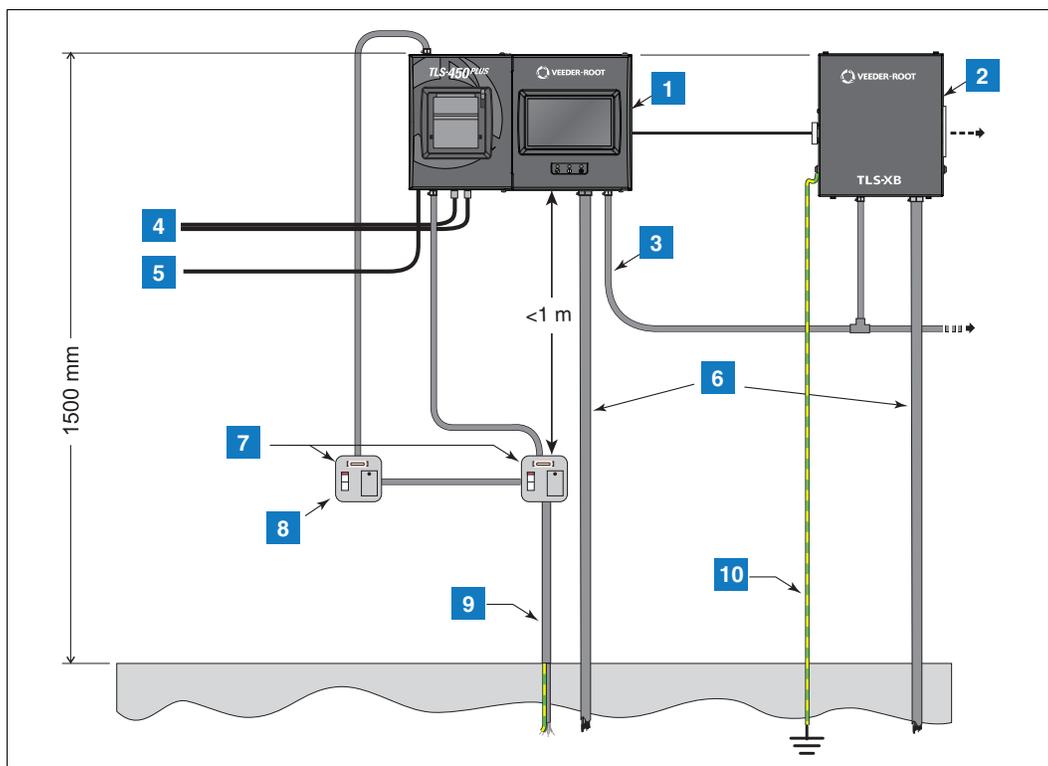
Esempio console TLS-450PLUS/8600 con installazione TLS-XB
